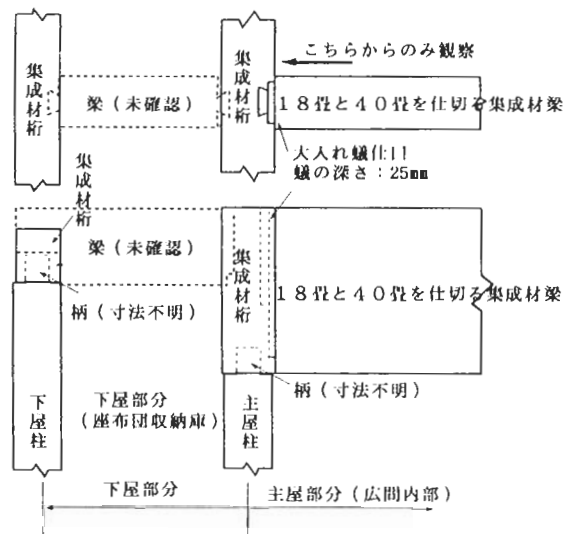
18畳間と40畳間の間を仕切る大断面集成
